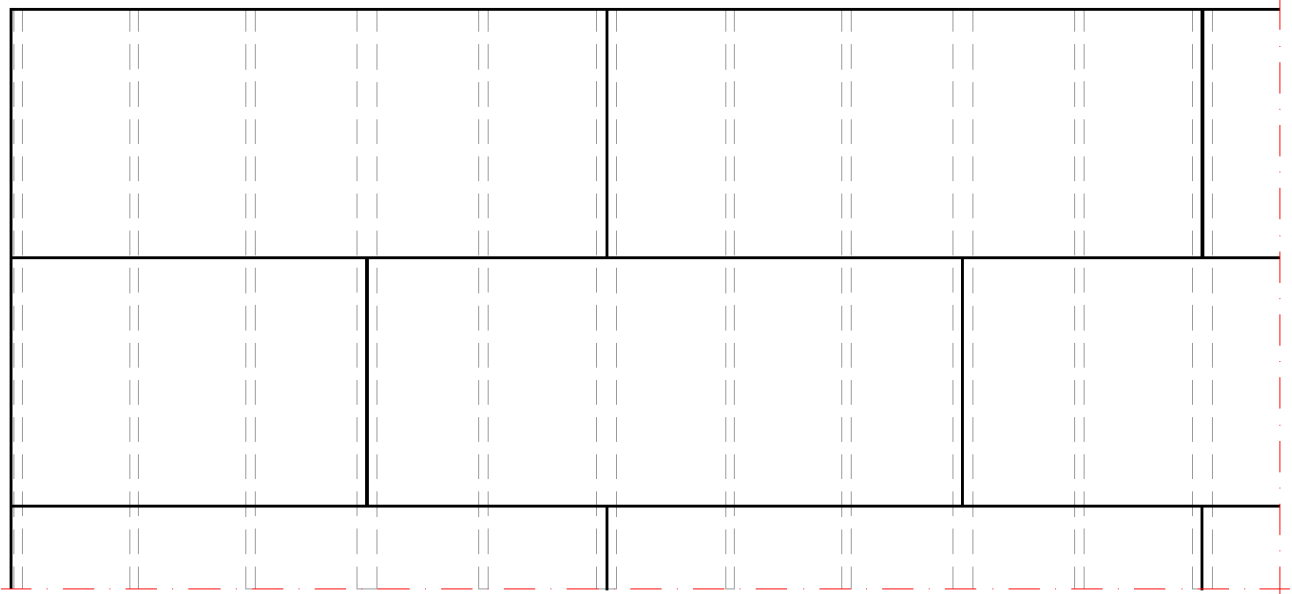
Disposition des panneaux, soutenus par des poutres
